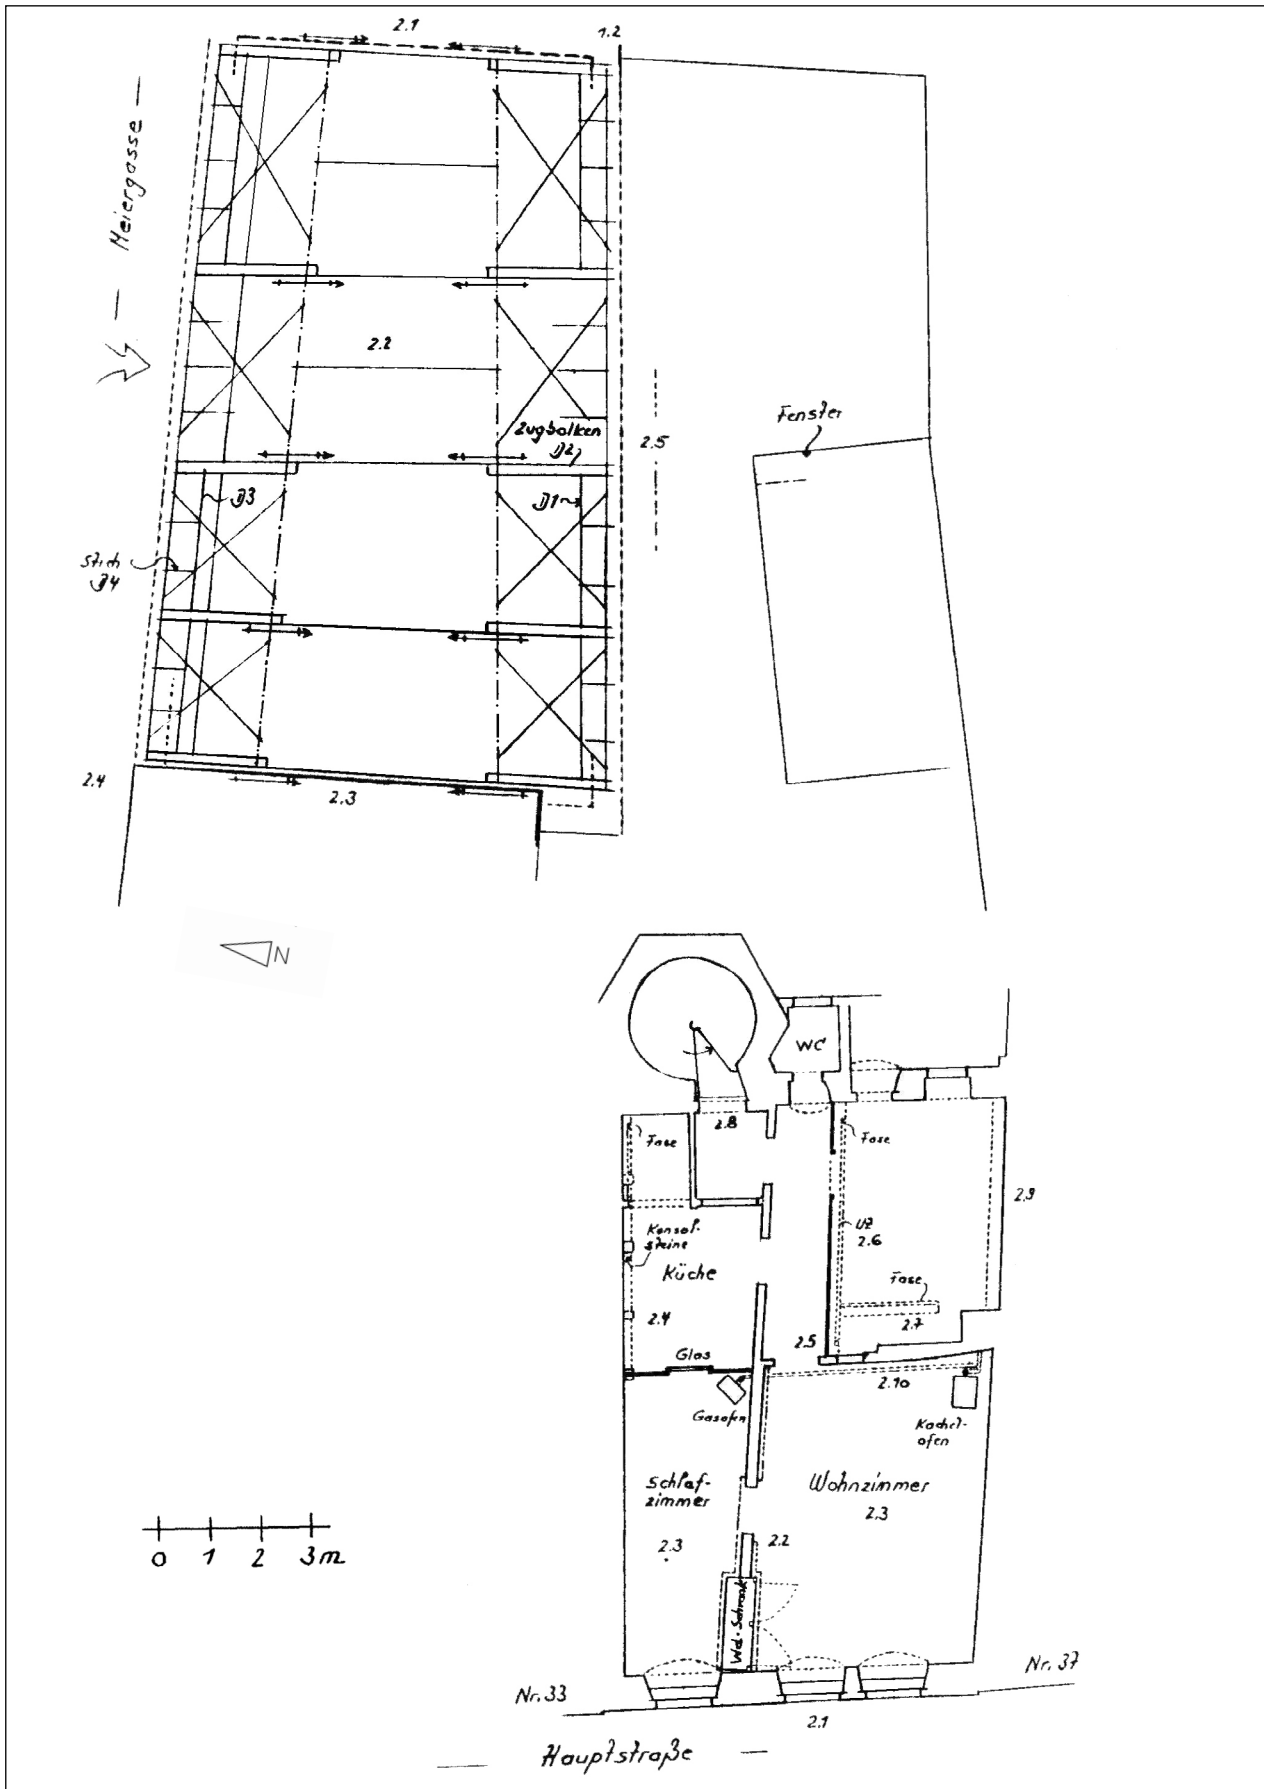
Hauptstraße 35, Grundriss 1. Obergeschoss, M. 1:150.
